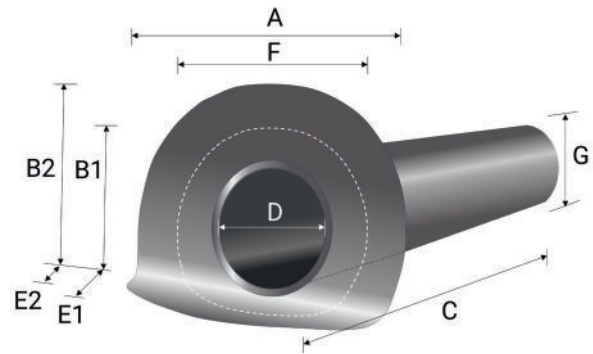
Flansch z.B. mit PVC-Dachbahn
